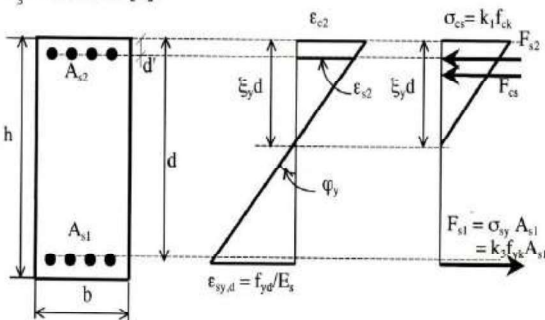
Comportement d'une section fléchie d'une poutre en béton armé à l'ELS
